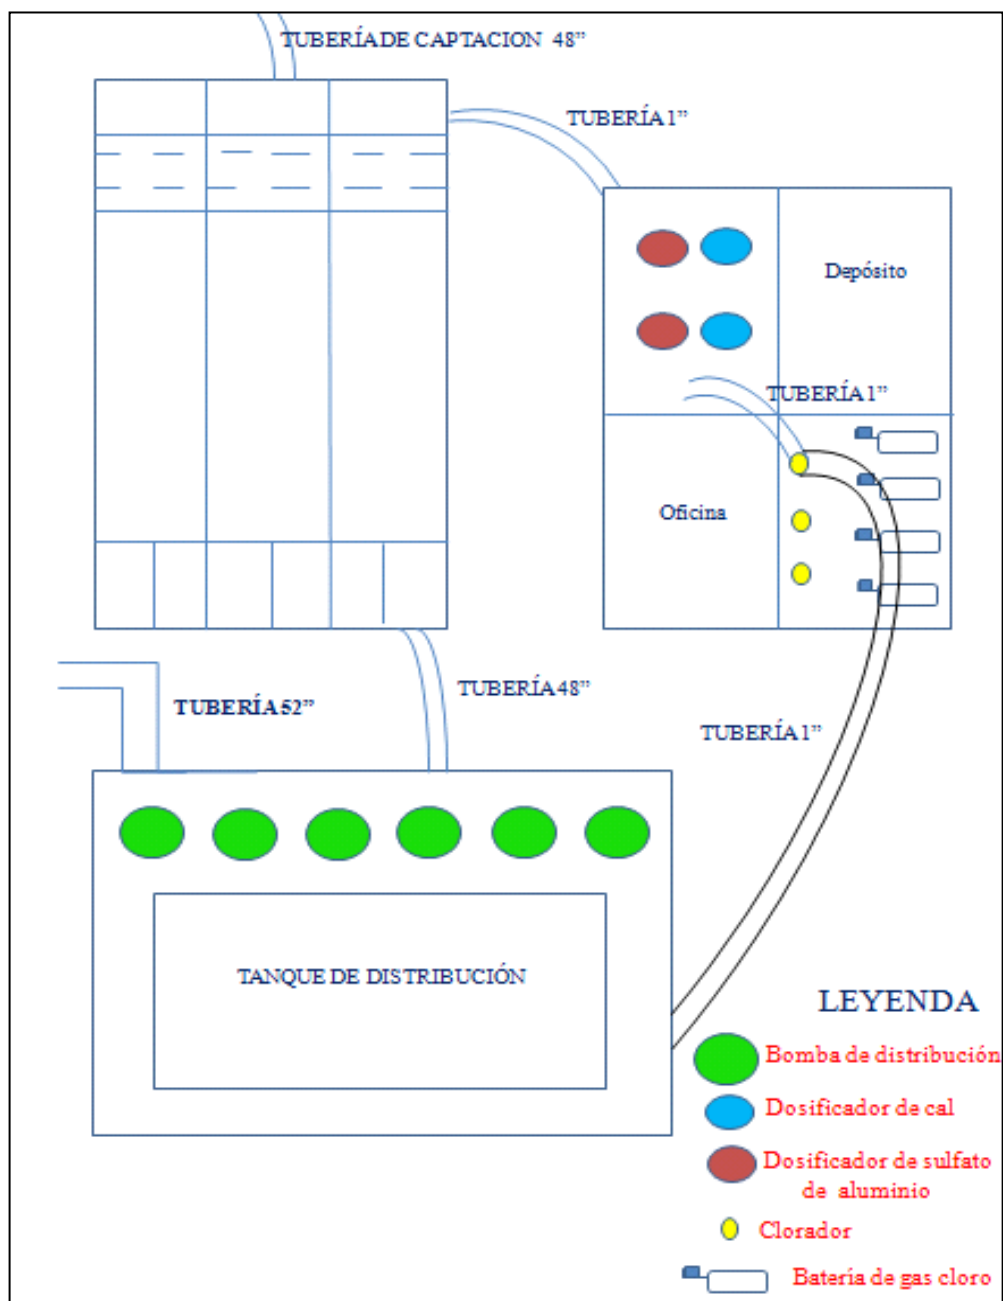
Croquis vista de planta con la distribución de los elementos que Intervienen en el proceso del agua potable.
